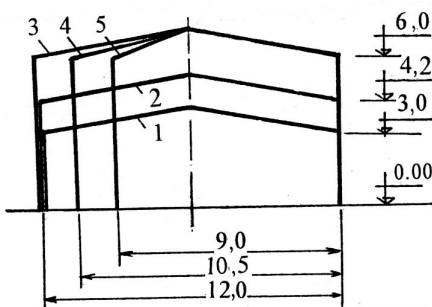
Совмещенная схема базисных расчетных схем УСП с разнозаменимыми конструкциями
